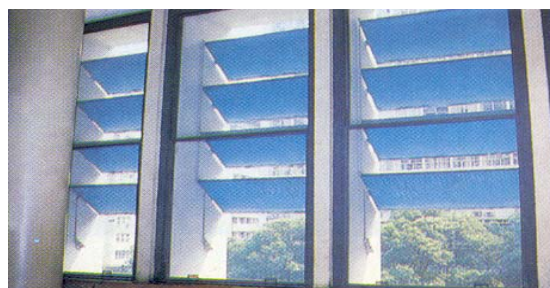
C – Fachada Norte/Quebra Sol
